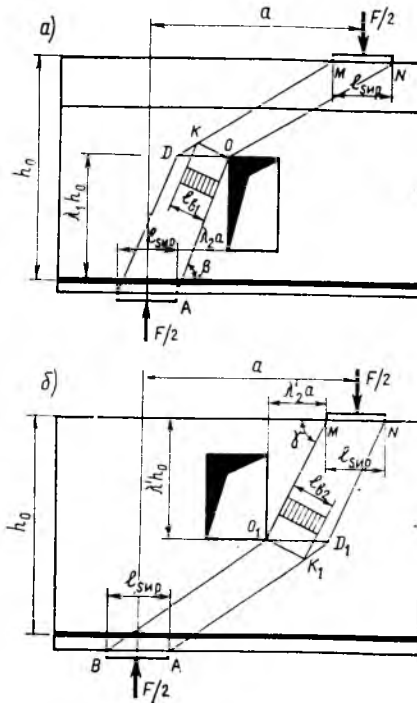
Расчетная схема балки по наклонной сжатой полосе, проходящей через верхний (а) и нижний (б) угол проема
